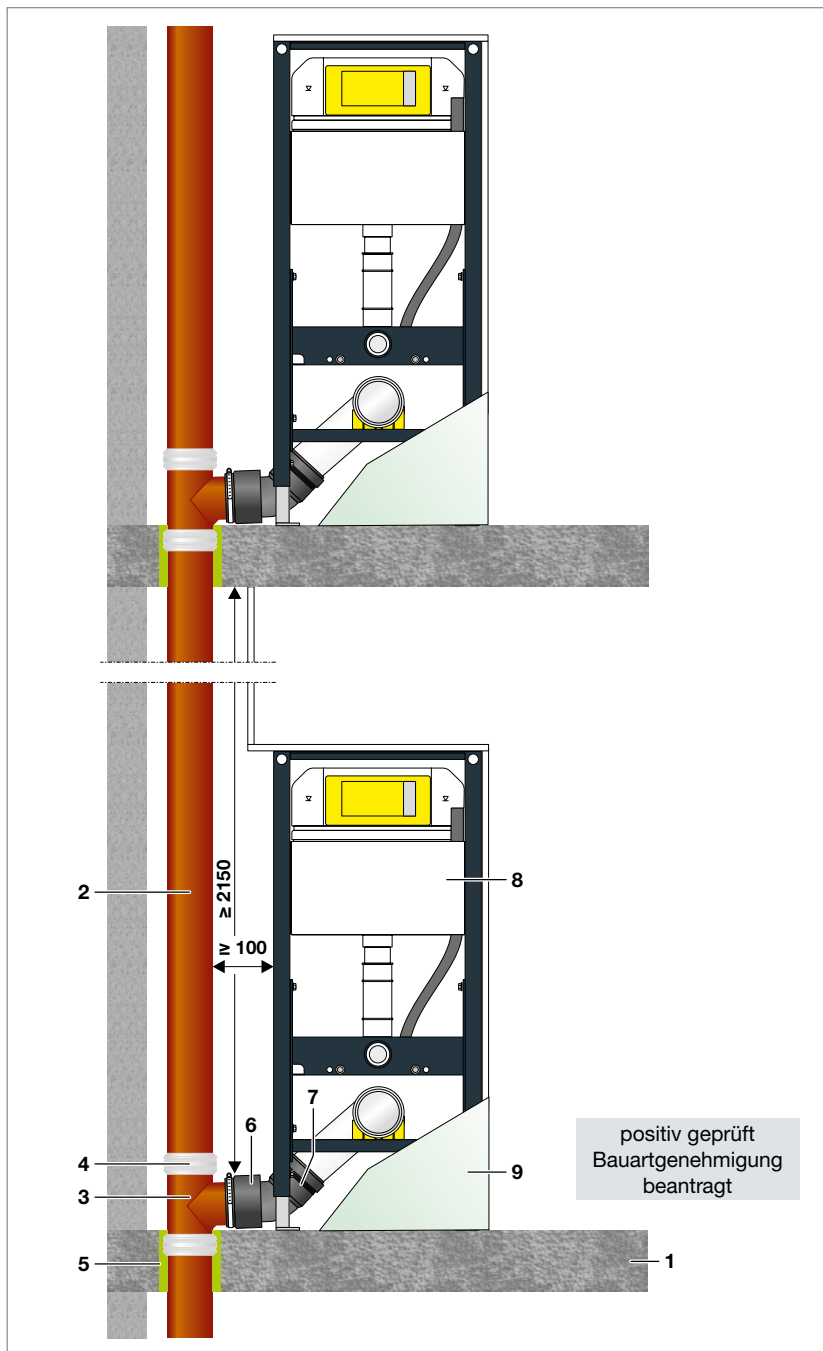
Aufbau Mischinstallation mit Viega Prevista Dry Plus/Prevista Dry
